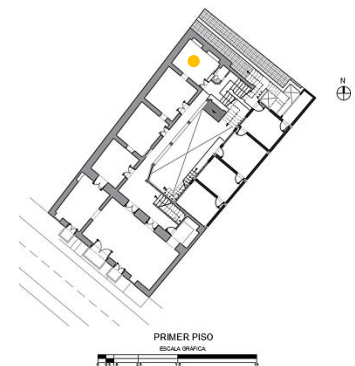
Humedad, líquenes y fisuras • Fuente: Ilustración Propia
